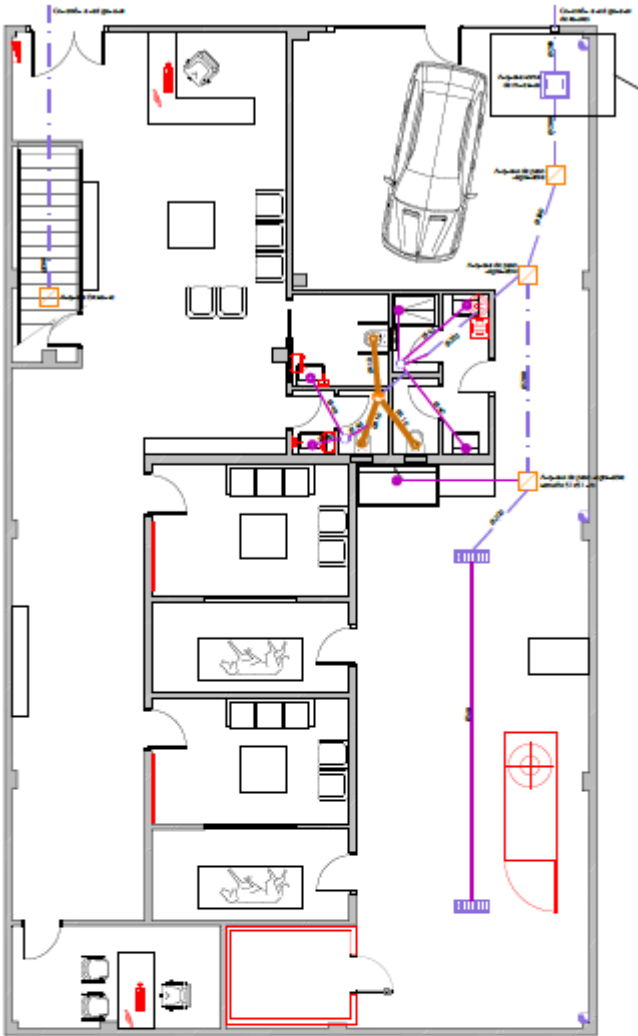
Detalle plano de saneamiento de las instalaciones
